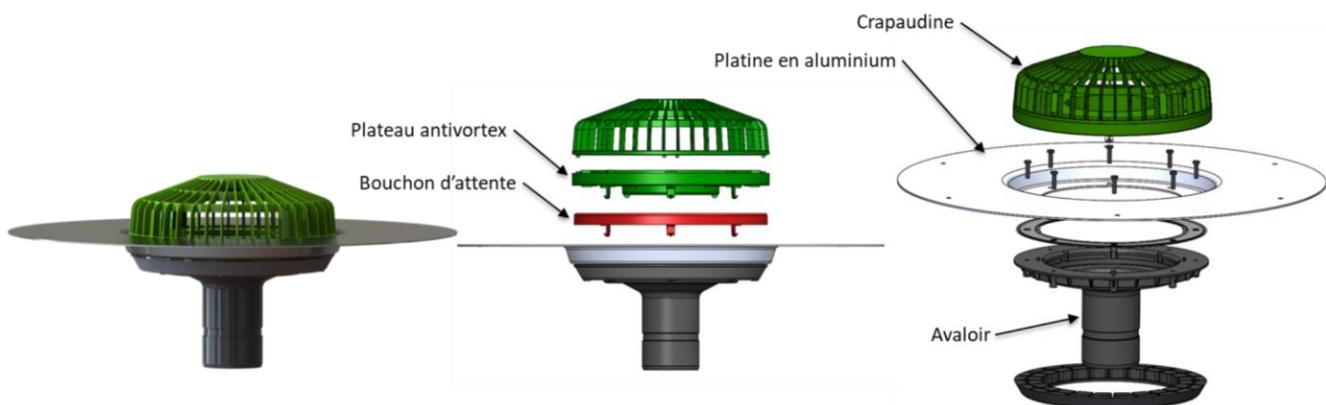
is : Schéma d'une naissance pour toiture étanchée (bitume, PVC-P)
